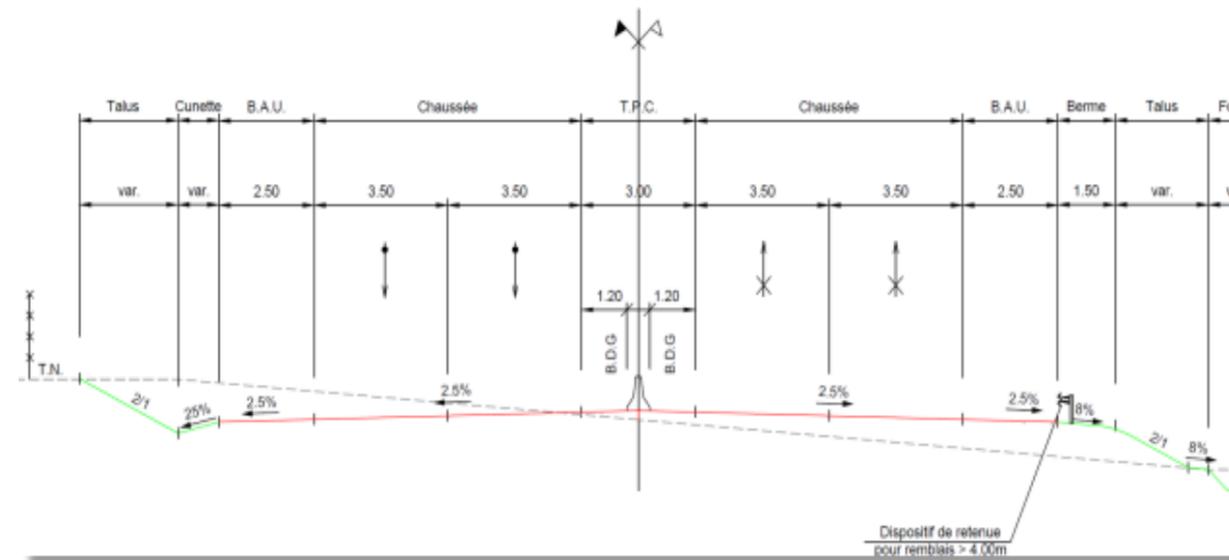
Profil en travers type de l'A150 Barentin / Écalles-Alix
